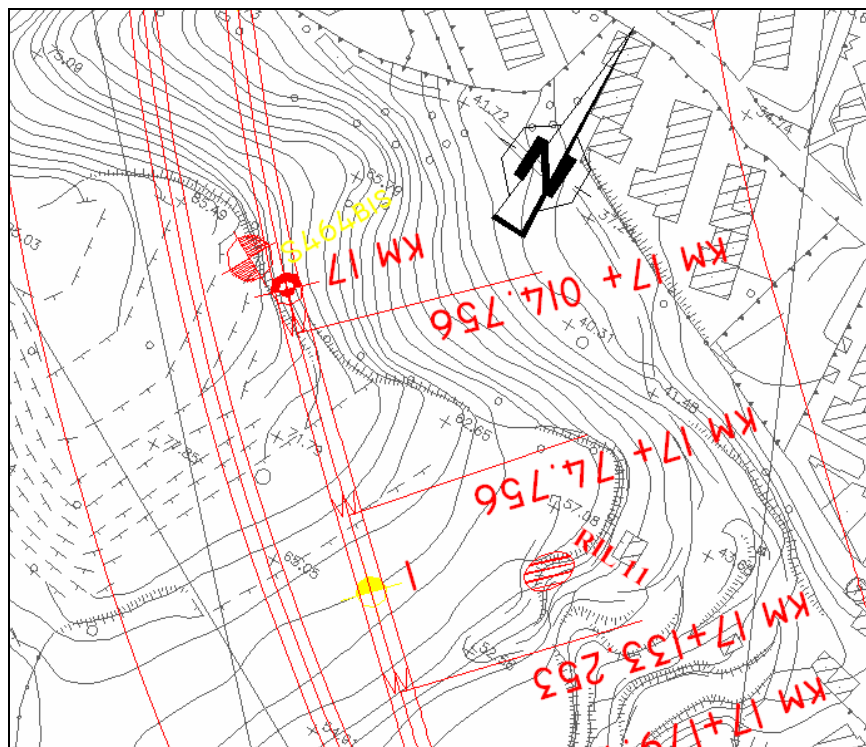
Ubicazione in planimetria dell'affioramento oggetto del rilievo geostutturale
